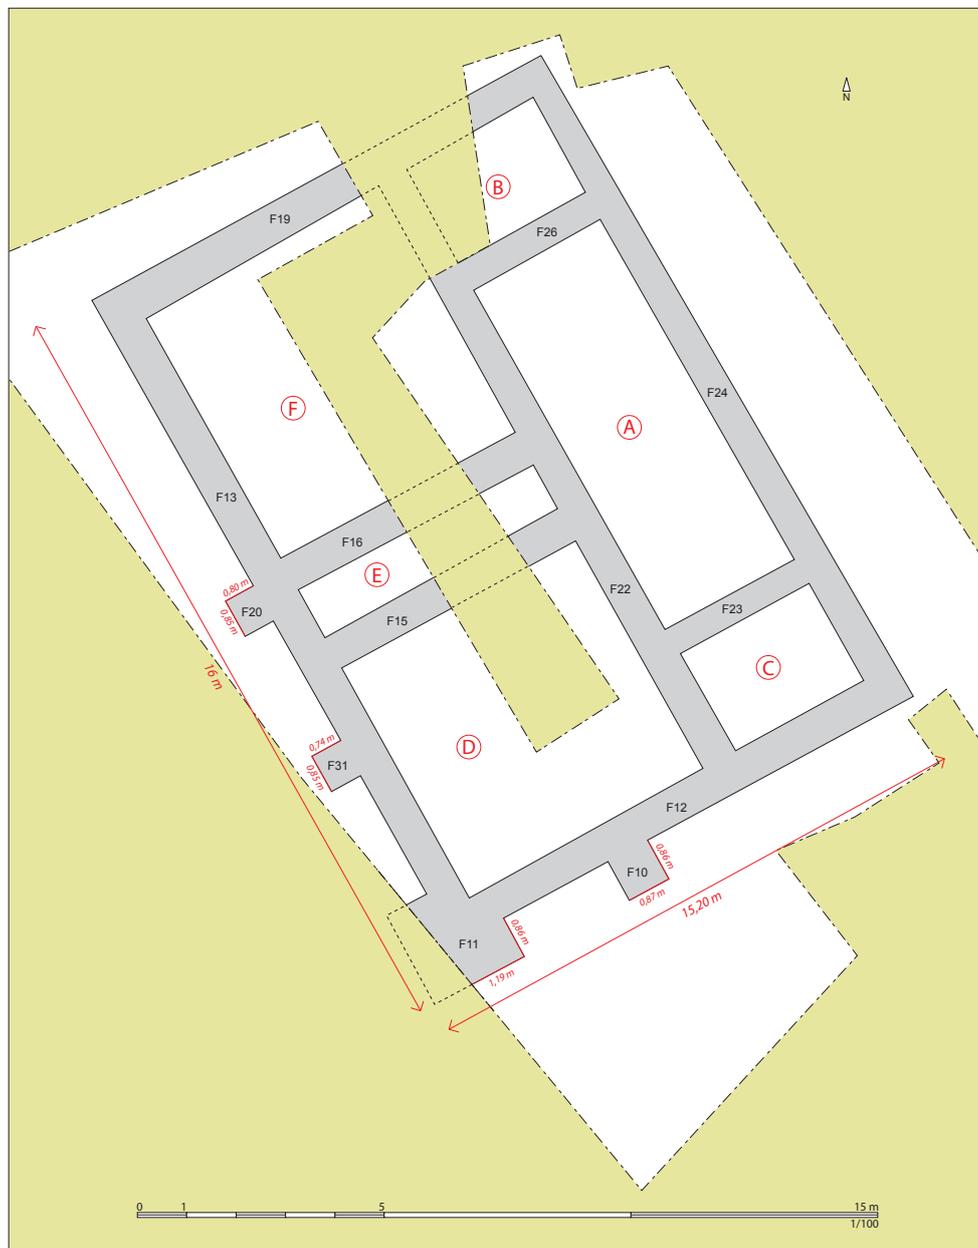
Plan général du bâtiment au 1/100^e (Erwan Bourhis).
